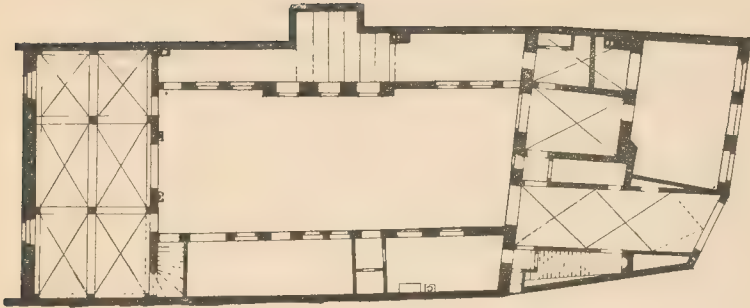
Haus D284. Grundriß des Erdgeschosses.
